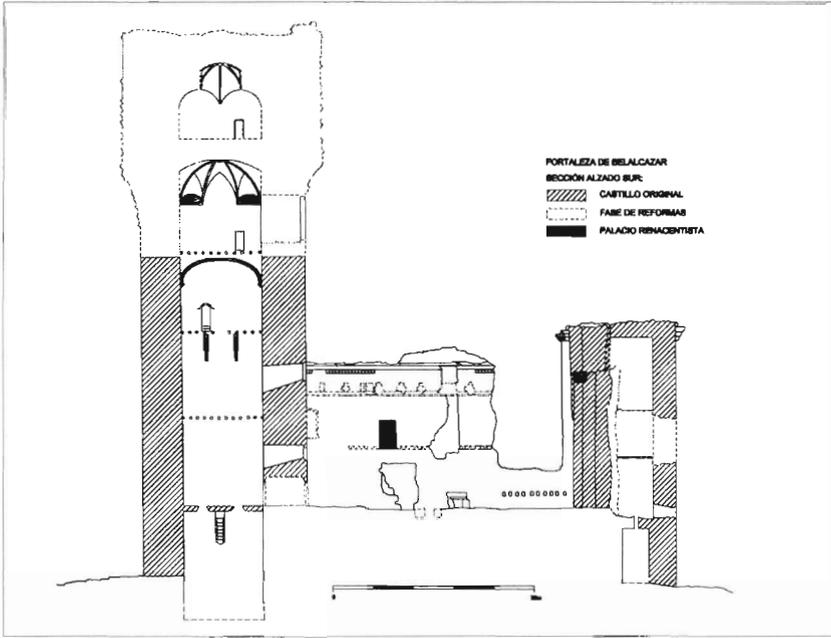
Fortaleza de Belcázar. Sección alzado sur.
